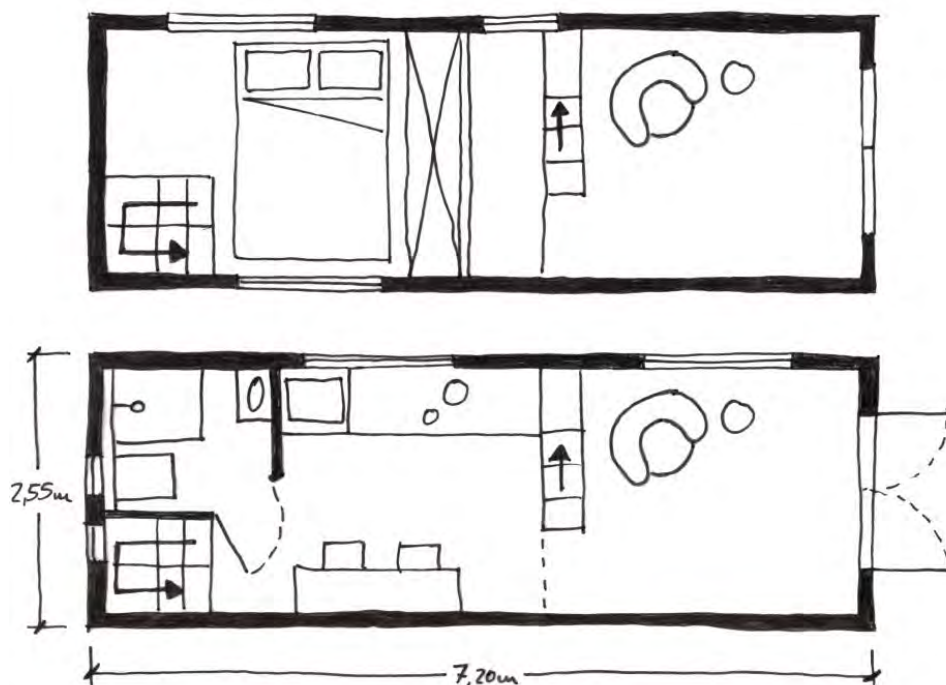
, Exemplarischer Grundriss eines „tiny-houses“
